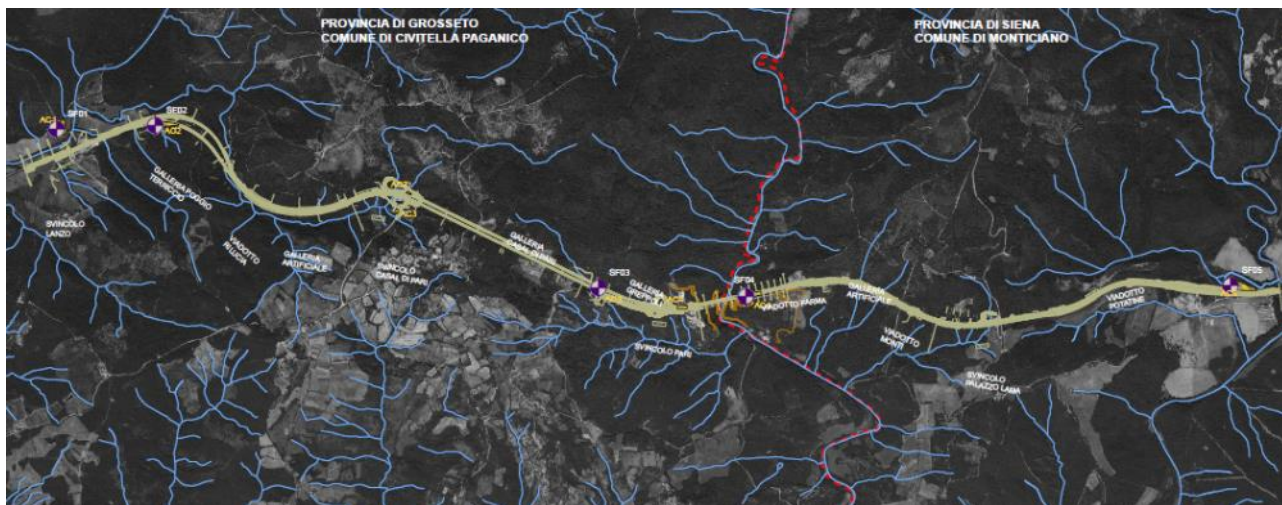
Planimetria generale – Stato fisico dei luoghi
